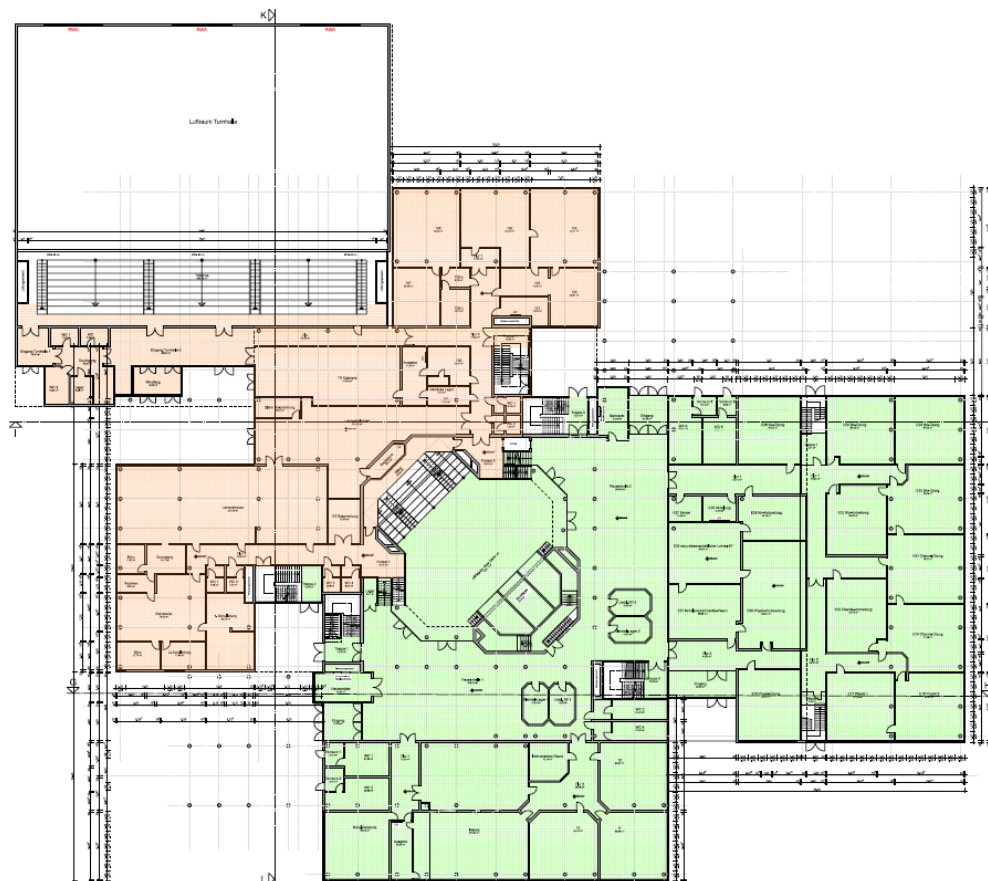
Grundrissausschnitt Erdgeschoss (Quelle: Mikler Architektur & Planung, Stand: 26.01.2021)
